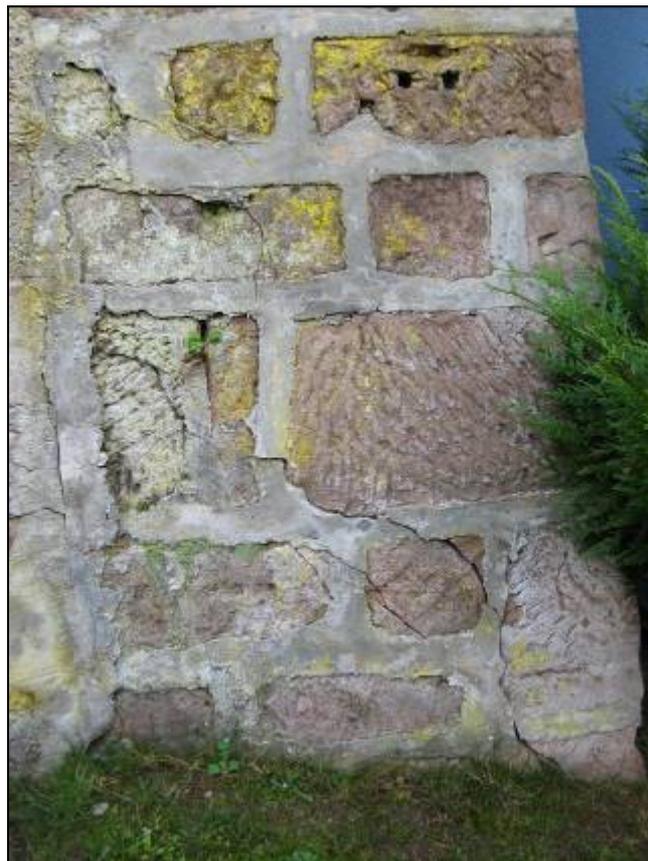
Fissure du mur de soutènement communal jointif, en contrebas sous la terrasse intermédiaire de M. Sahling (accès à partir de la parcelle 146).
